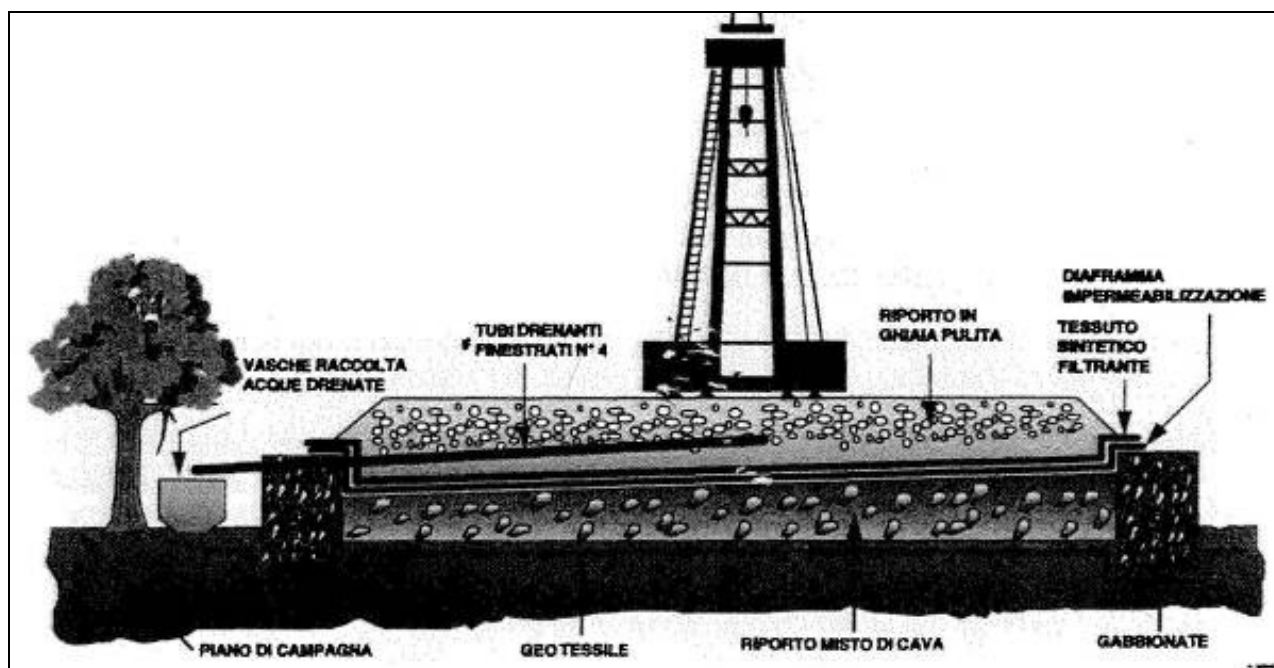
sezione schematica tipica di una piazzola di perforazione
